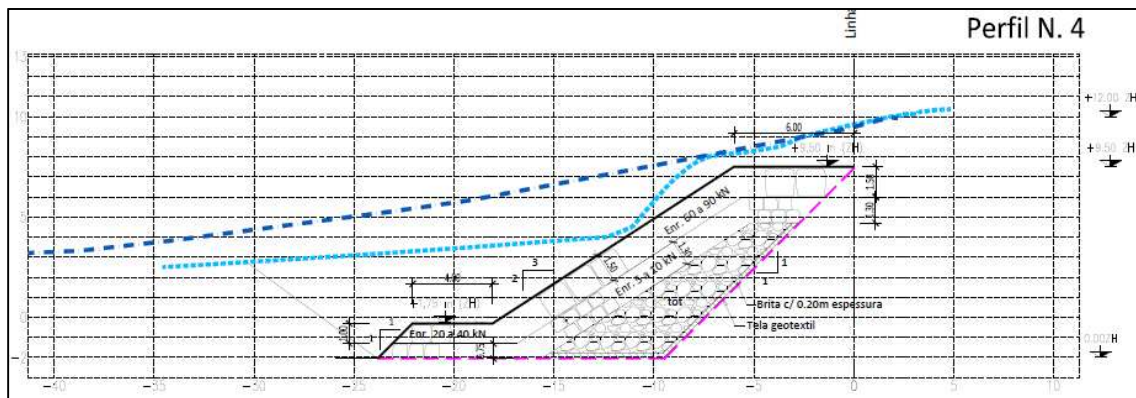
Troço do Centro Azul – Perfil 4 (fonte: APA, fevereiro de 2014)
